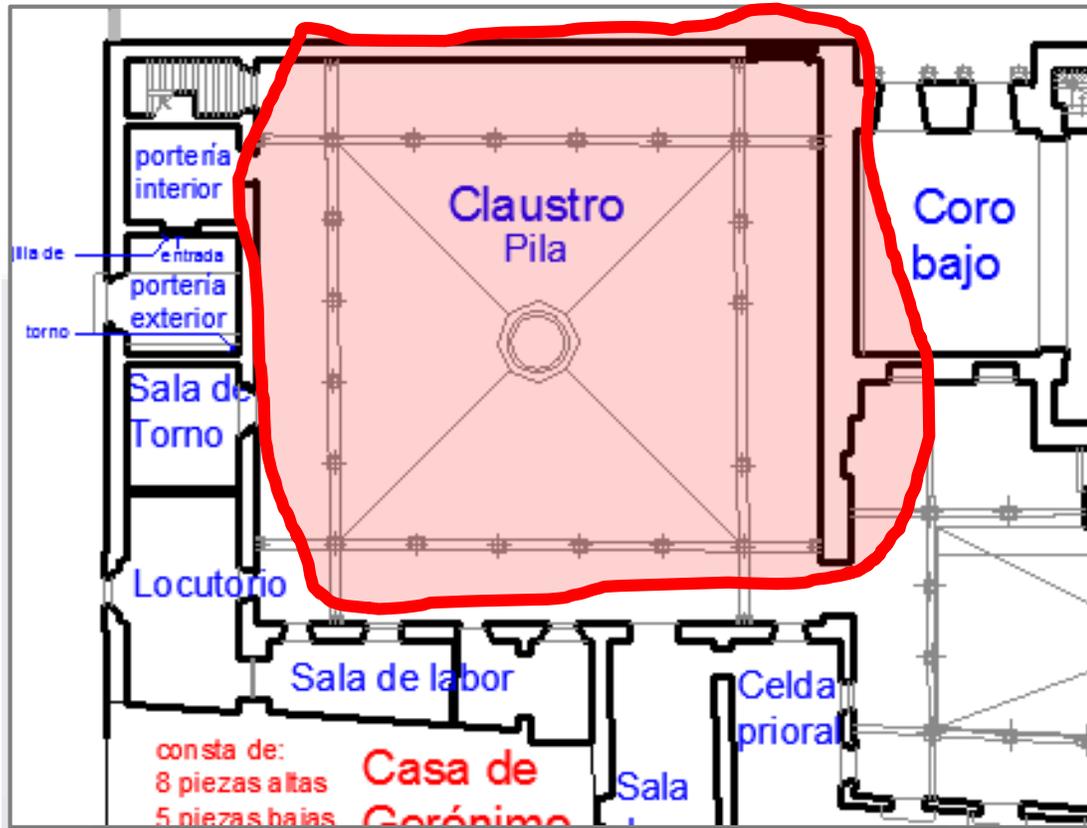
Planta del claustro principal del convento. Elaboración JMTV
